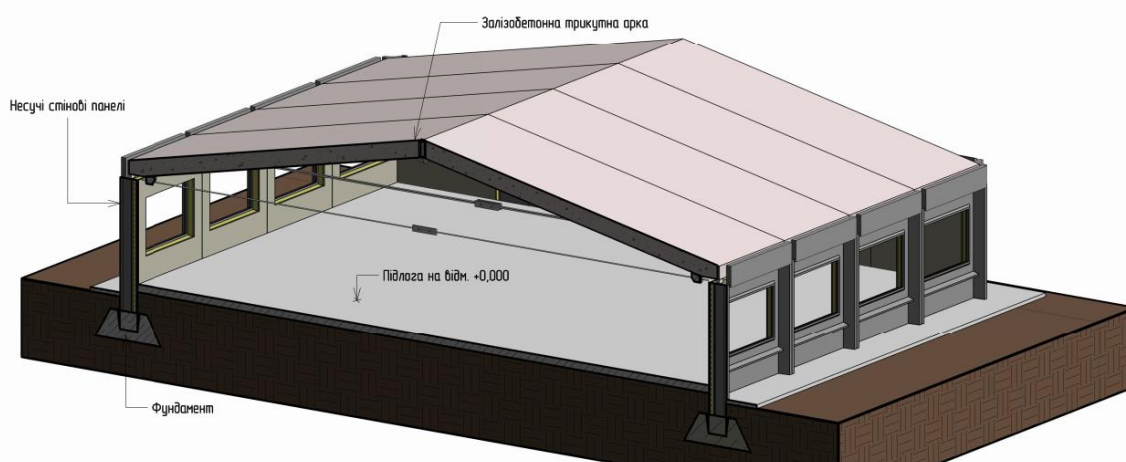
Конструктивна схема залізобетонних збірних швидкокомтованих будівель
